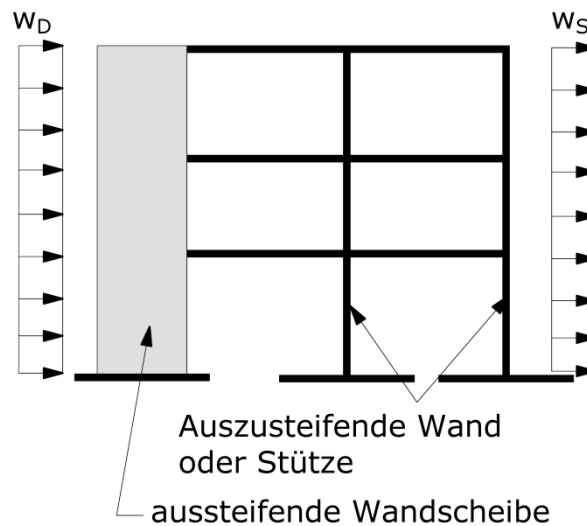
Statisches System zur Berechnung der Aussteifung
